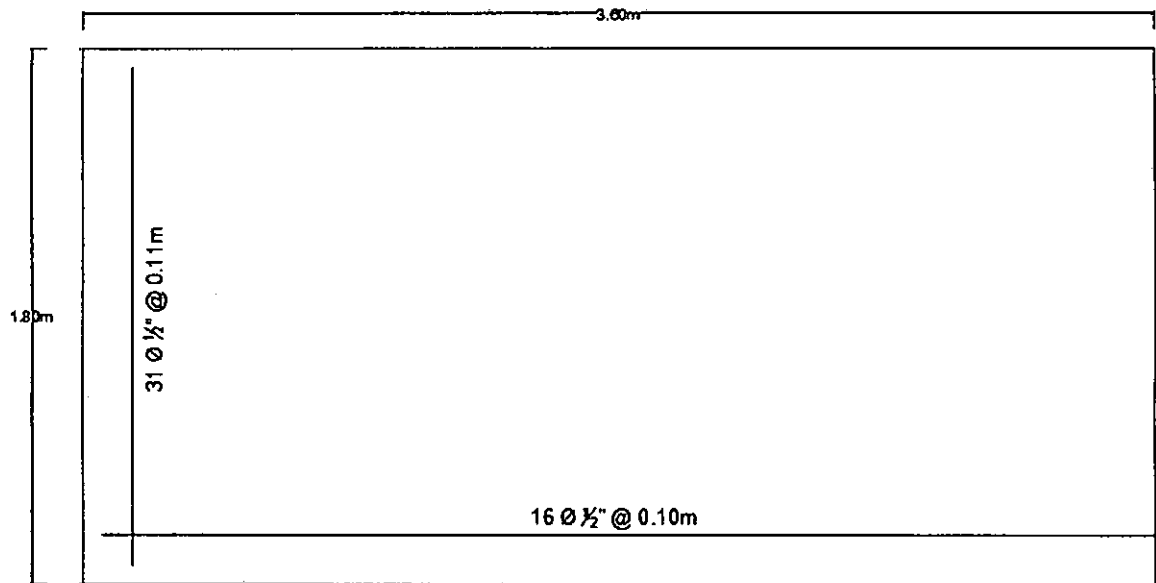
Distribución de acero de refuerzo en zapata Z5
